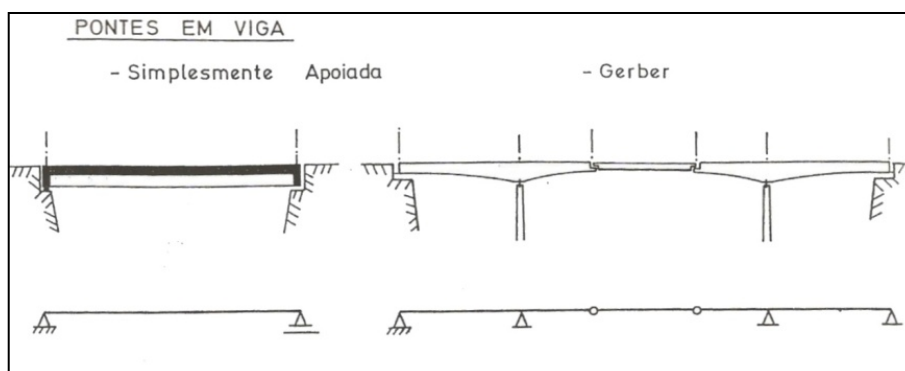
, Desenho Esquemático de Pontes em Viga Simplesmente Apoiada e Gerber.
